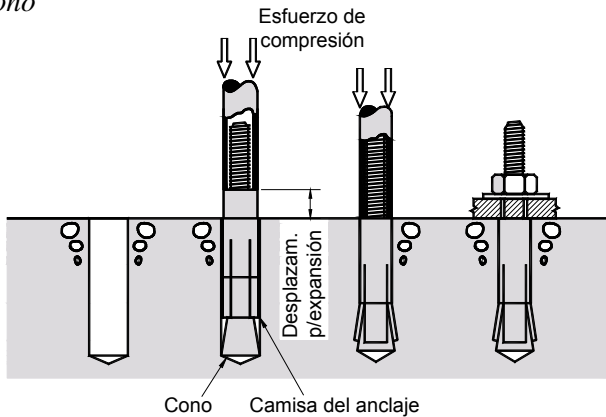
(d) – Anclaje rebajado Tipo 4: Anclaje de desplazamiento controlado que corta su propia muesca al ser instalado martillando la camisa sobre el cono
